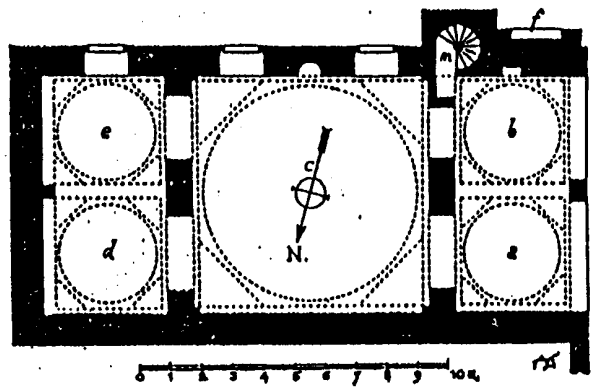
مسقط أفقي للجامع الخزفي في اسكدار (عن : Bauty)
